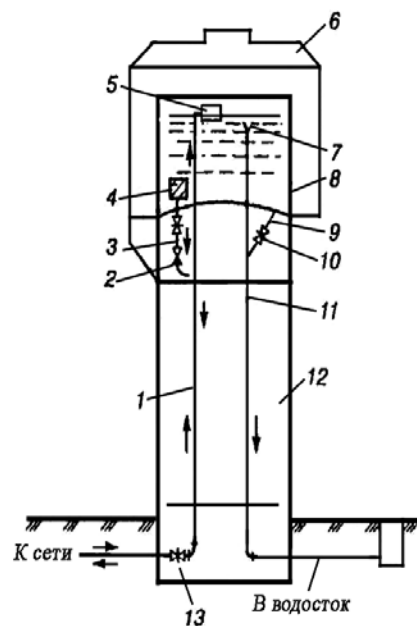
Схема оборудования водонапорной башни трубопроводами:
